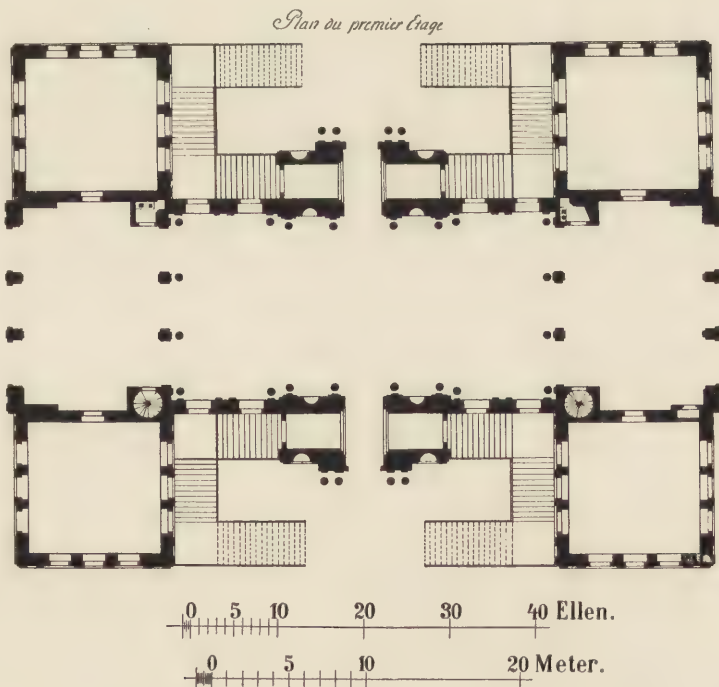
Palais im Grossen Garten. Grundriss des Obergeschosses.
